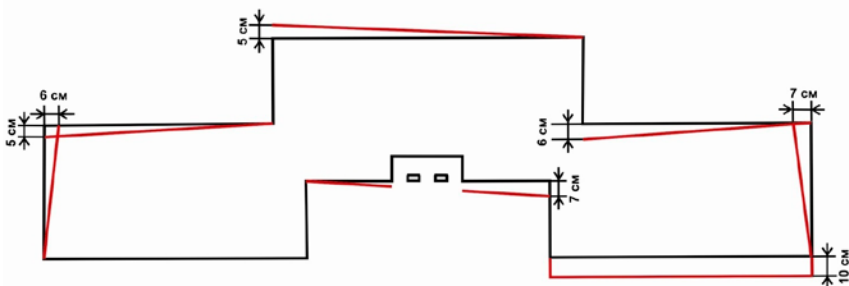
Схема смещения стен здания в плане относительно эталонной плоскости, проведенной через стену левого крыла здания
